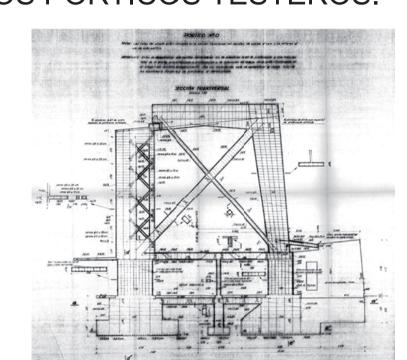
Pórtico 0 de Apoyo al Oeste. Las rótulas Freyssinet en pies y cabeza de Planta Baja permite considerarlo un apoyo deslizante.
